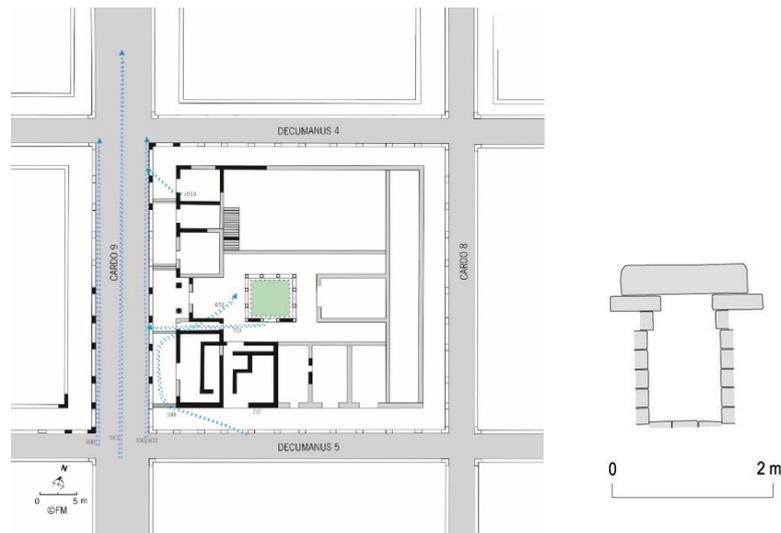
Planta com as estruturas hidráulicas e pormenor da secção da cloaca @Magalhães, 2019
